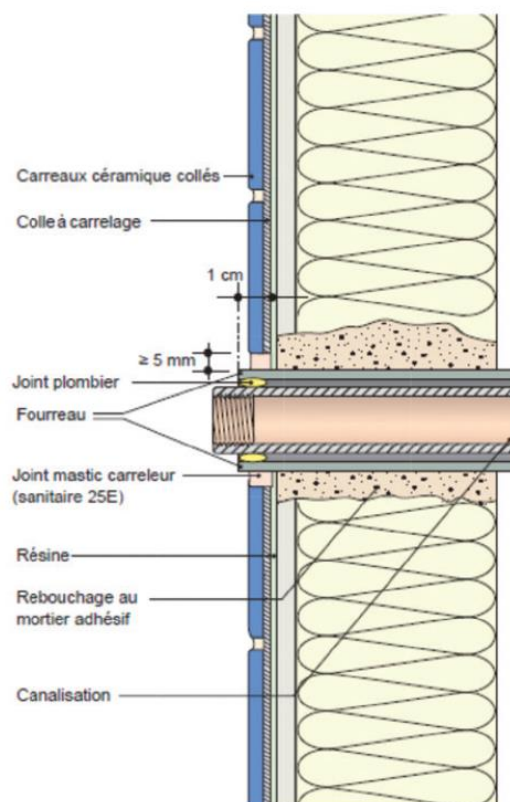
Traitement d'une canalisation traversante avec fourreau en paroi verticale ; exemple d'une cloison en plaque de parement en plâtre.
